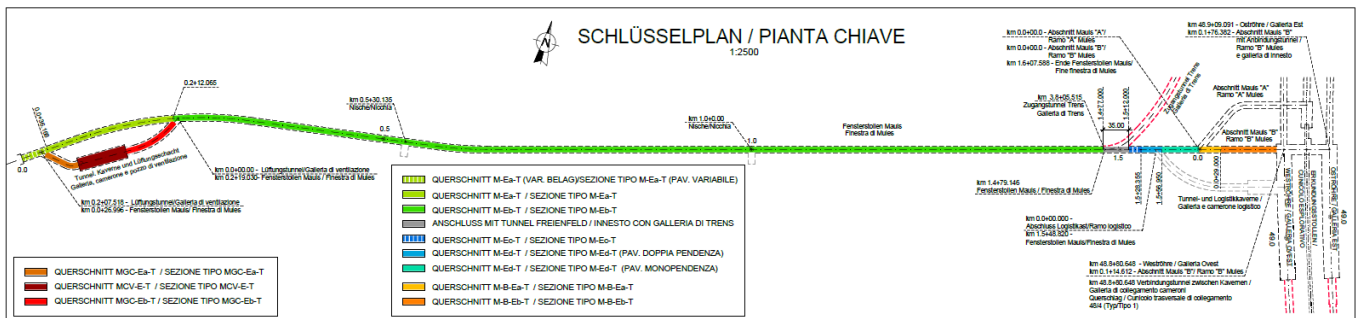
Schlüsselplan Fensterstollen MauIs und dazugehörige Bauwerke [102]
